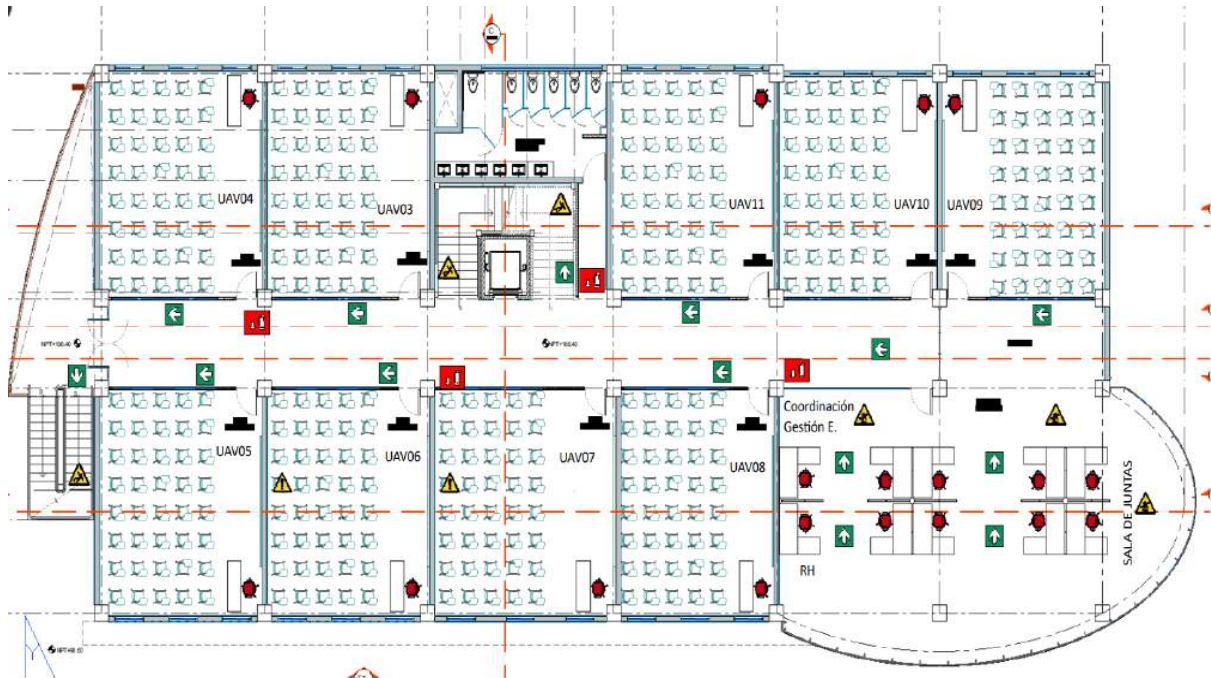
Plano edificio vertical primer nivel, Fuente (Canchola & Vela, 2023)
